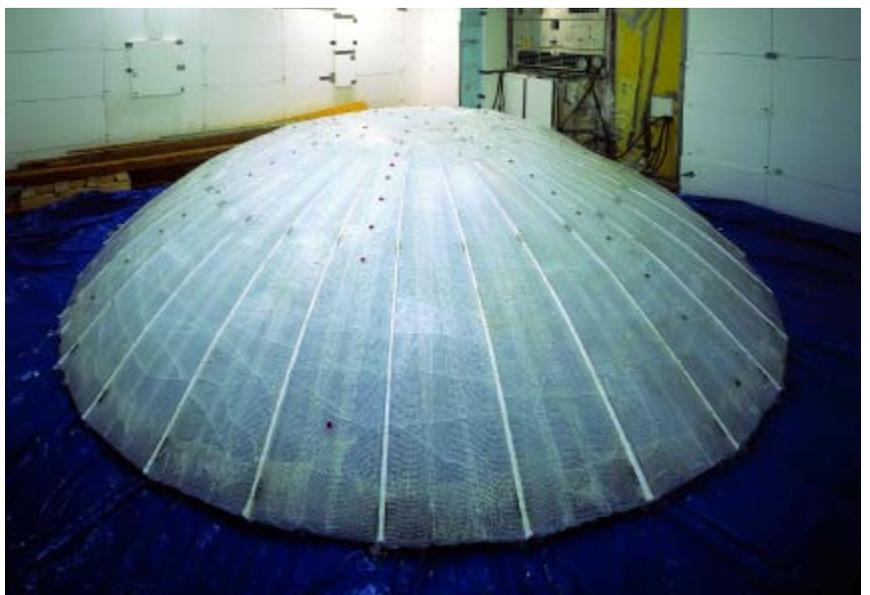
Betonieren der Stahlbetonplatte mit 10 m Durchmesser
